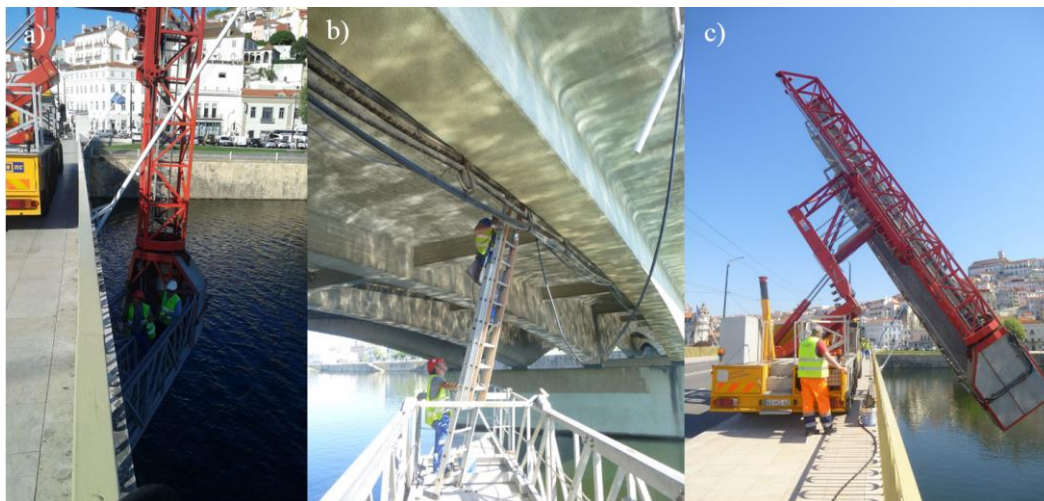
a) Grua *under bridge* em execução de trabalho, b) instalação do cabo novo tripolar de BT da rede de IP, c) grua *under bridge* a ser recolhida.
